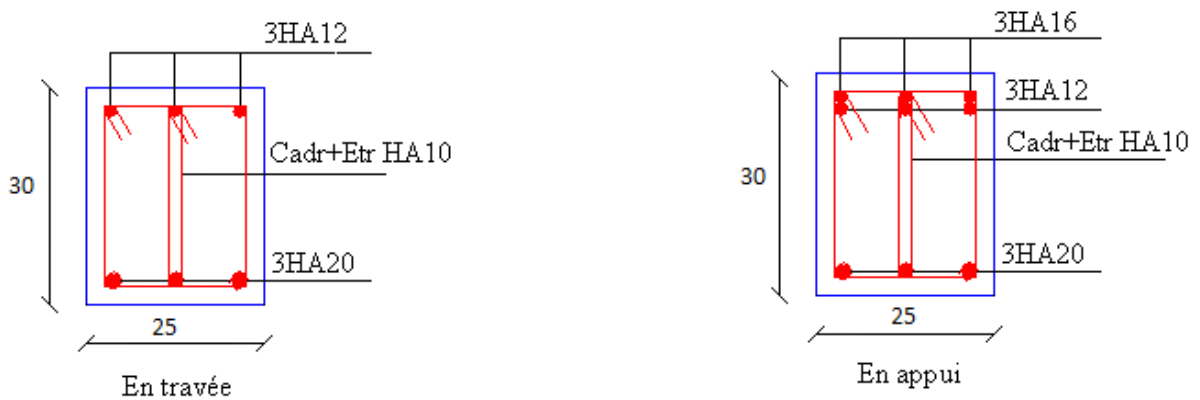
Schéma du ferrailage des poutres secondaires 5^{ème}entr Sol et Parking
